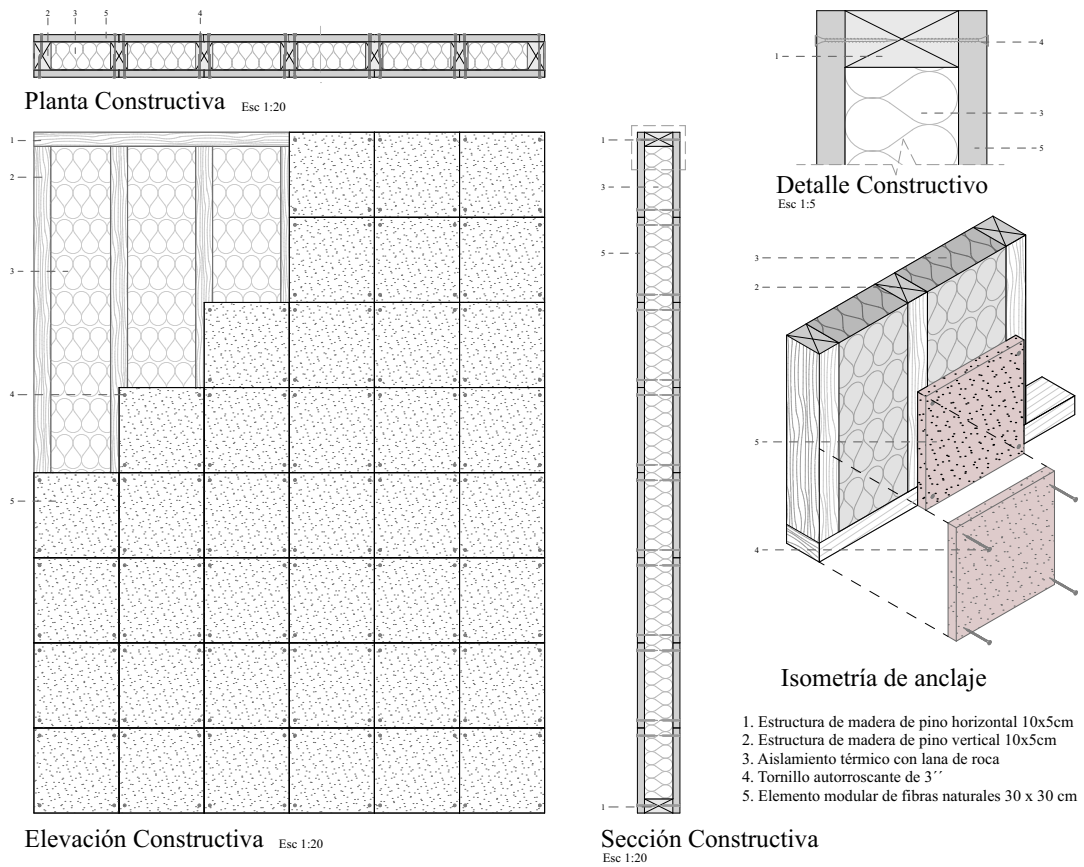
Detalle constructivo para tabiquería liviana diseño 1. Fuente: autor
